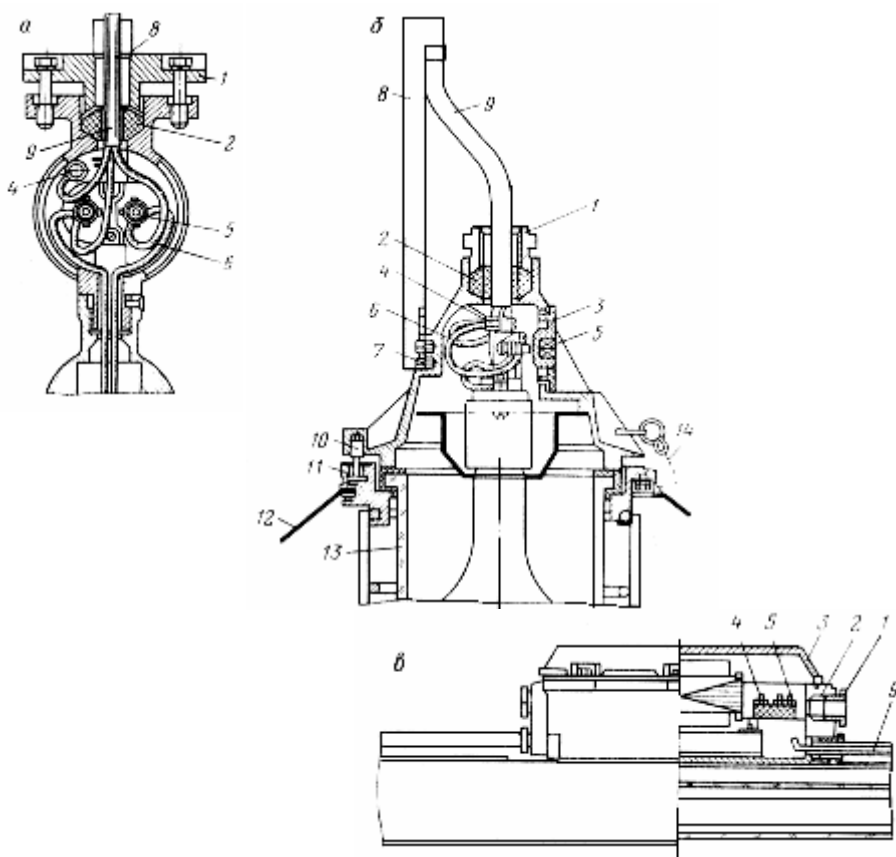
Монтаж кабелей в вводных устройствах светильников:
